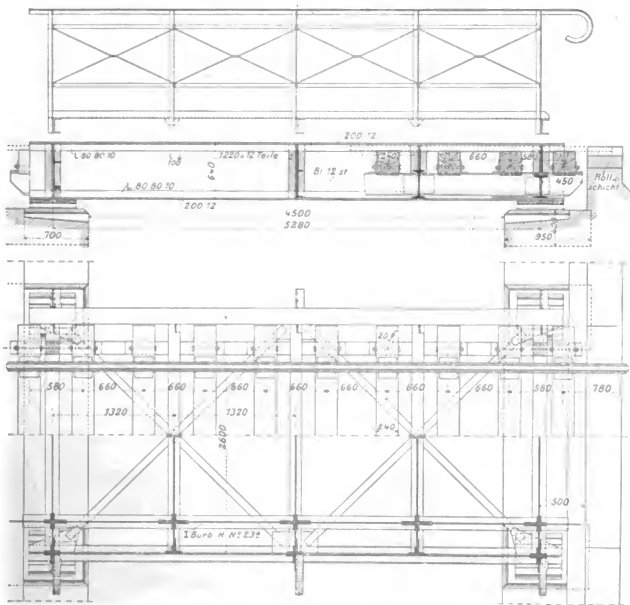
u. 312. Grundriß und Horizontalschnitt.
